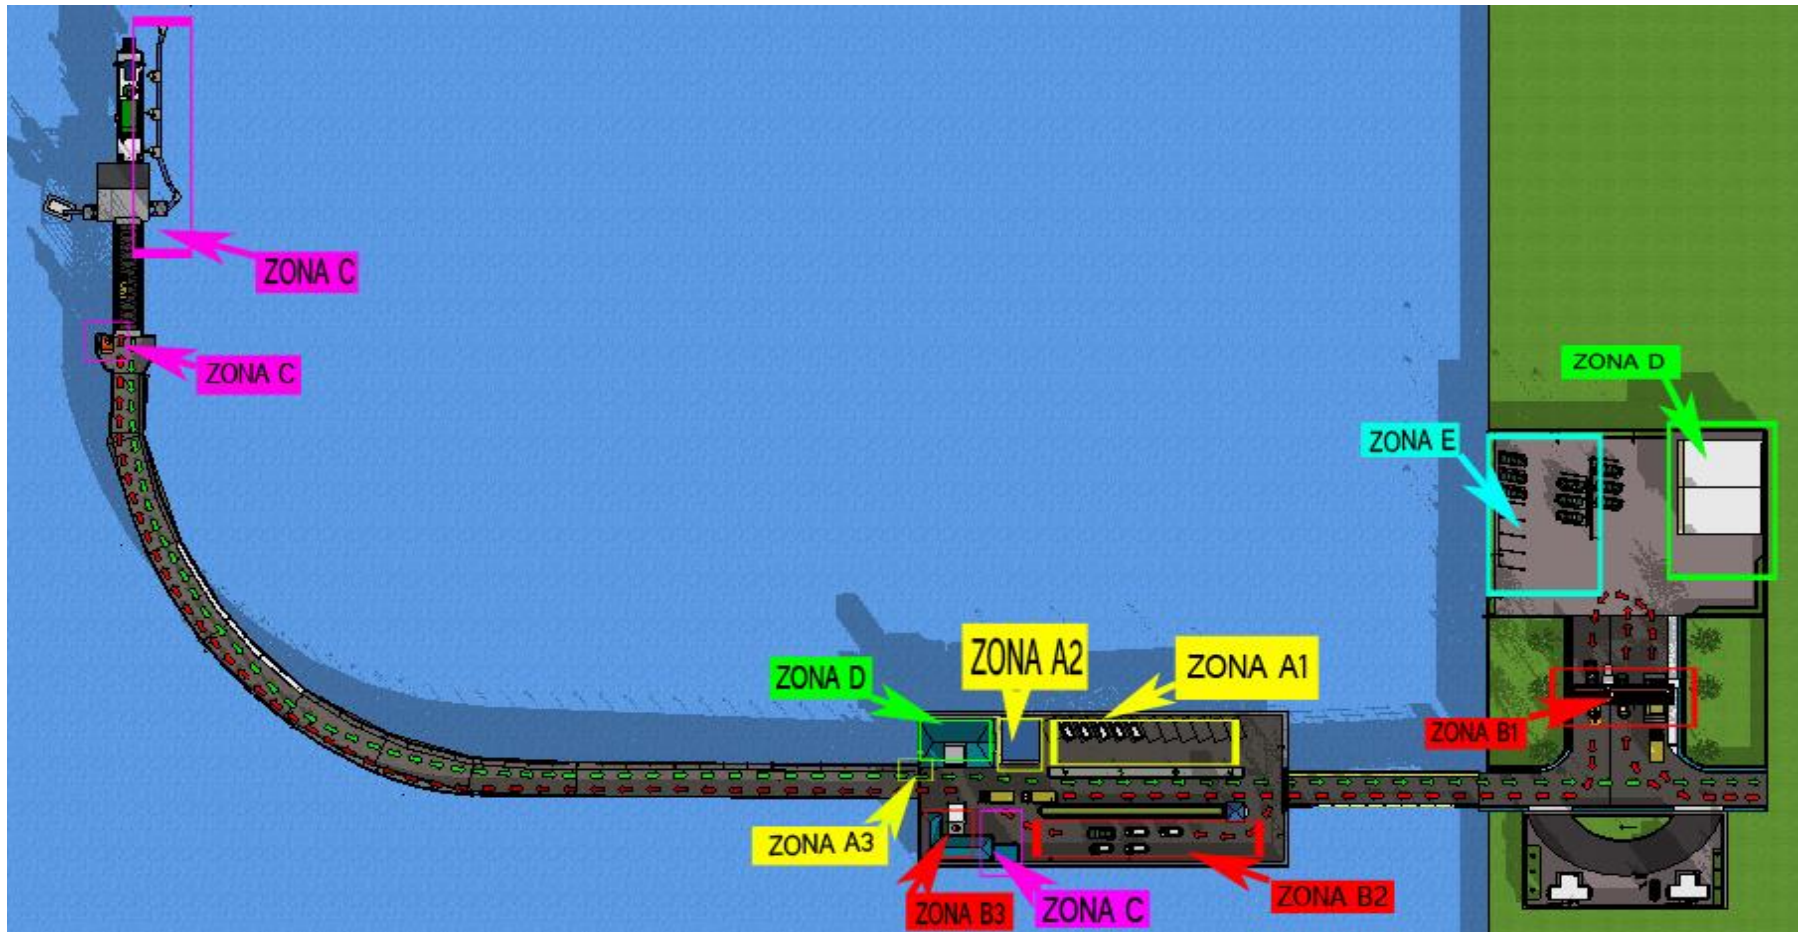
Daerah rencana pembangunan Zona B1 (Jembatan timbang dan Tollgate) Zona D (Daerah komersil) dan Zona E
